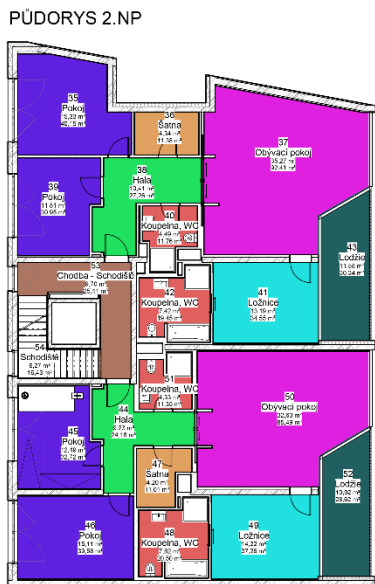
Půdorys typického nadzemního podlaží – vlastní zpracování
